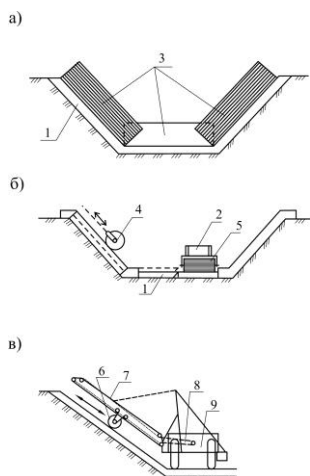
Уплотнение бетонных смесей при бетонировании канала
